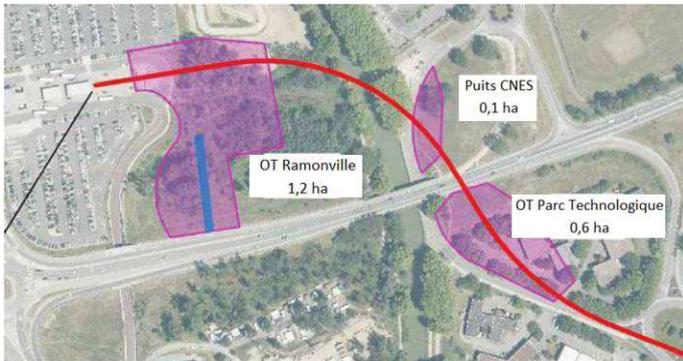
Schéma des installations de chantier et accès aux zones de travaux – Source : Arcadis AVP1
